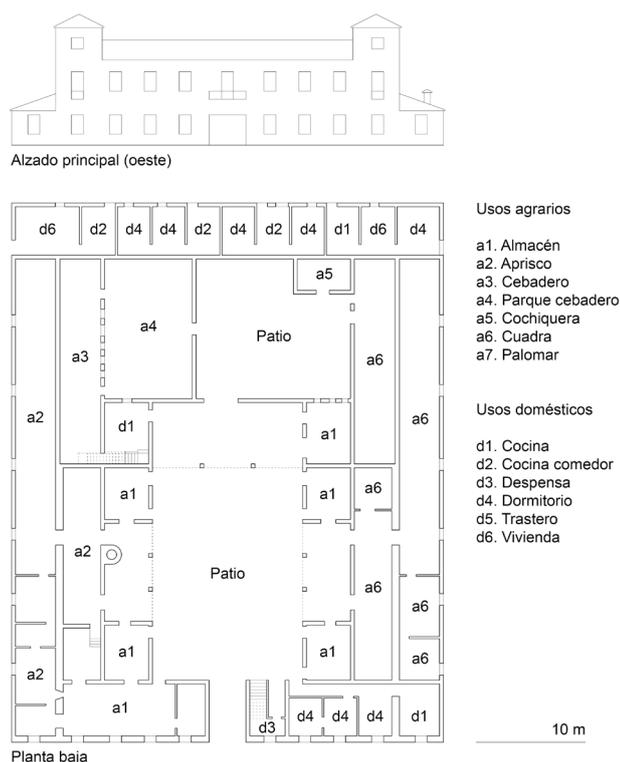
Planta baja y alzado principal de la casa de la Venta o venta del Chaparral que fue demolida para la construcción del pueblo de colonización de El Chaparral. Fuente: Elaboración propia.
